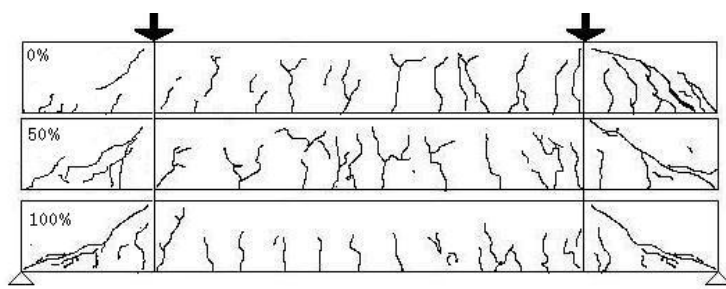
ひび割れ発生状況 ($a/d=2$)
